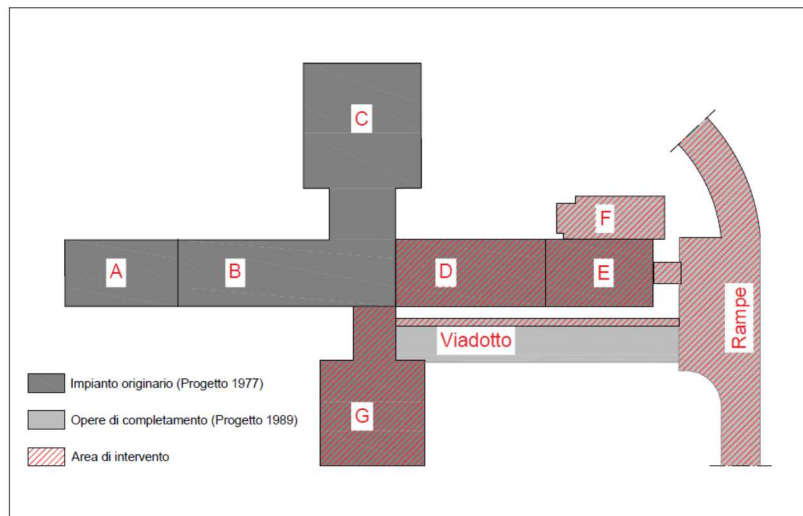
Le fabbriche ed i collegamenti interessati dall'intervento
